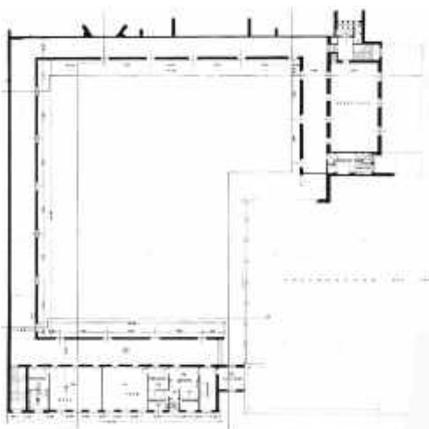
Chioostro, pianta piano primo, progetto di restauro
